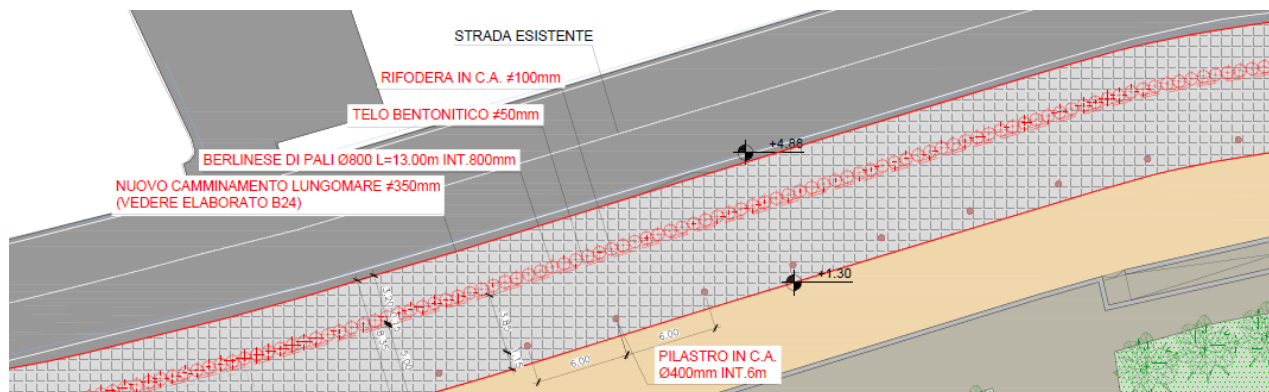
Estratto dalla Tavola C10 "Planimetria strutturale di progetto" - individuazione della berlinese
